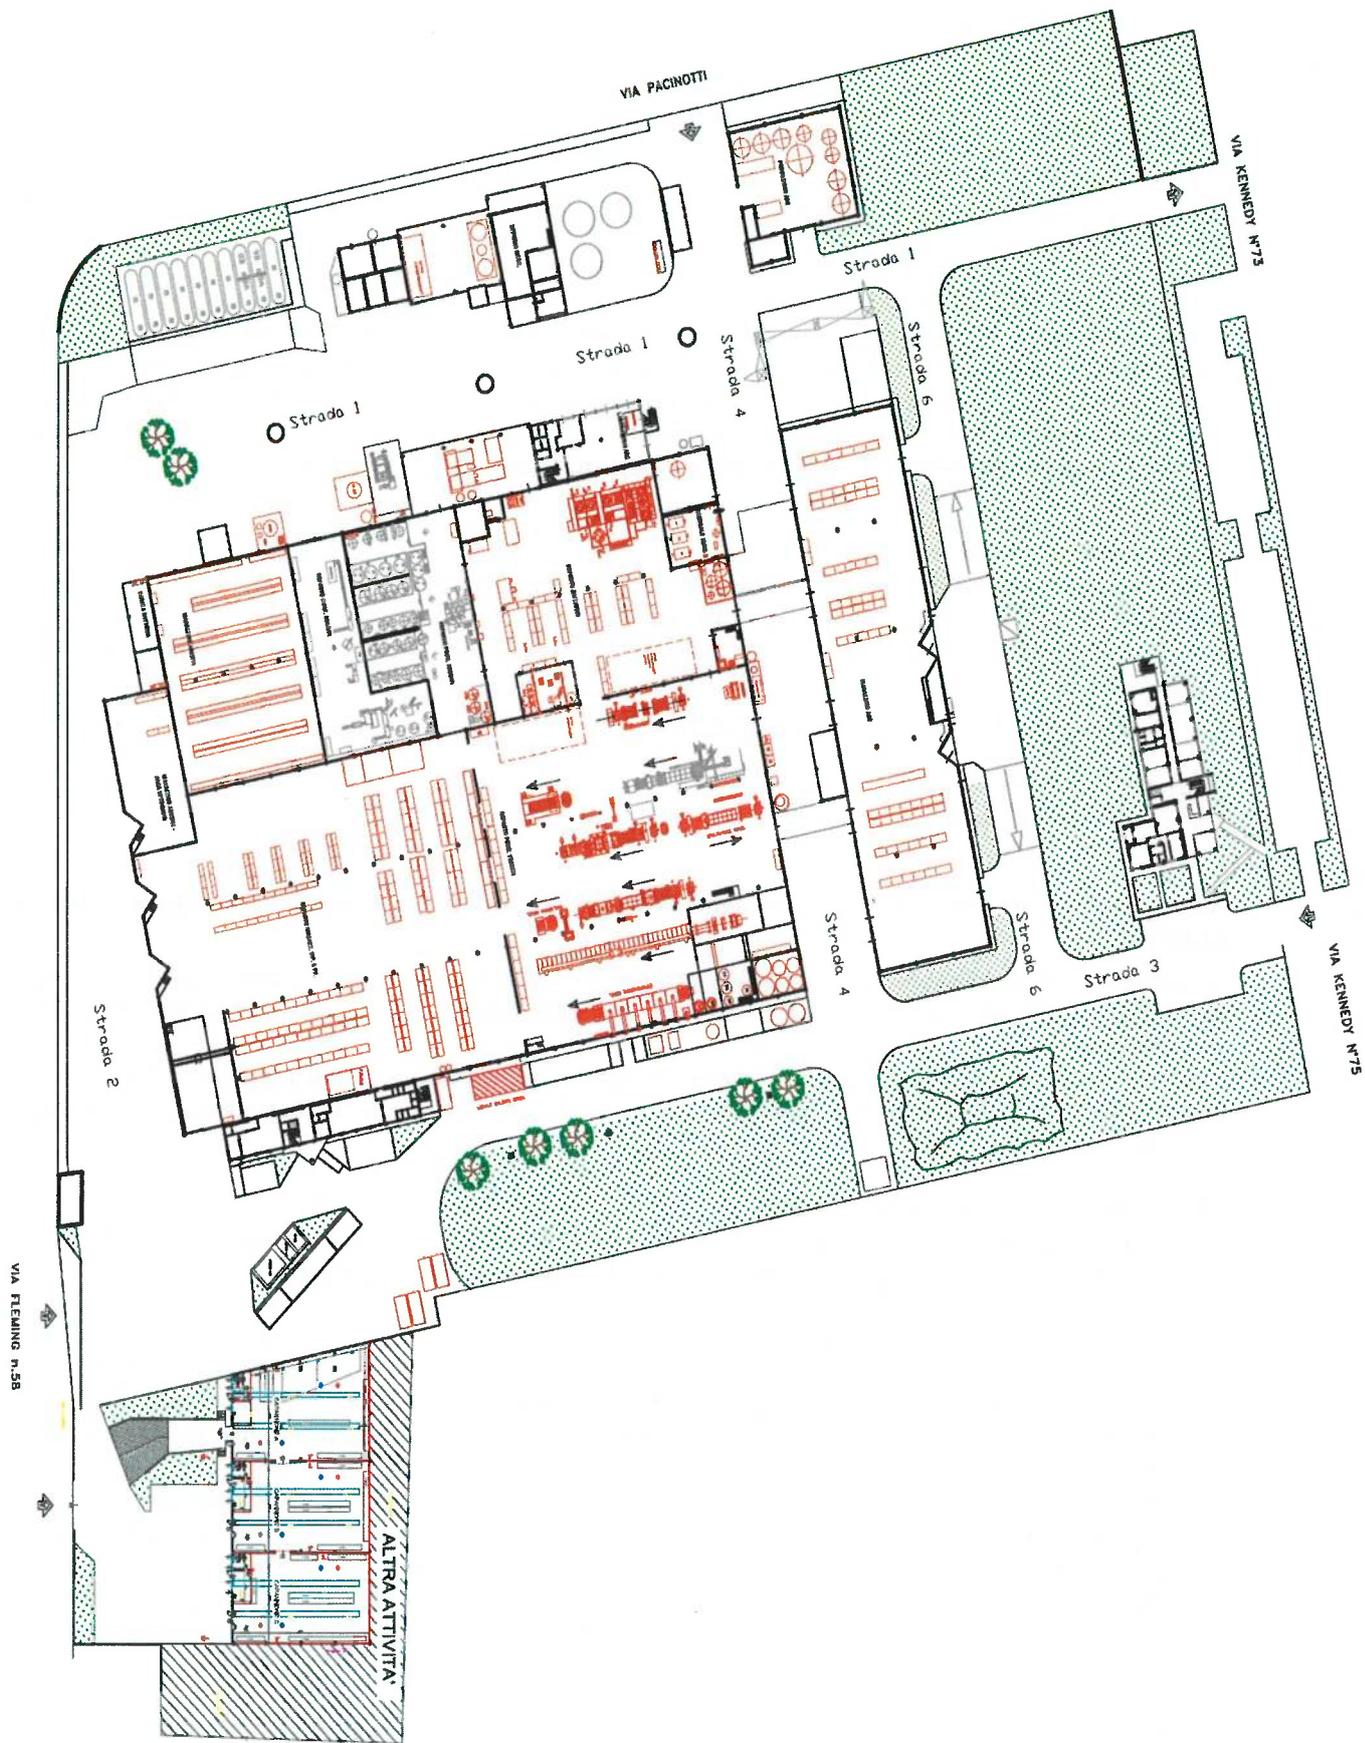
Pianta del sito aziendale. Scala 1: 1600.
